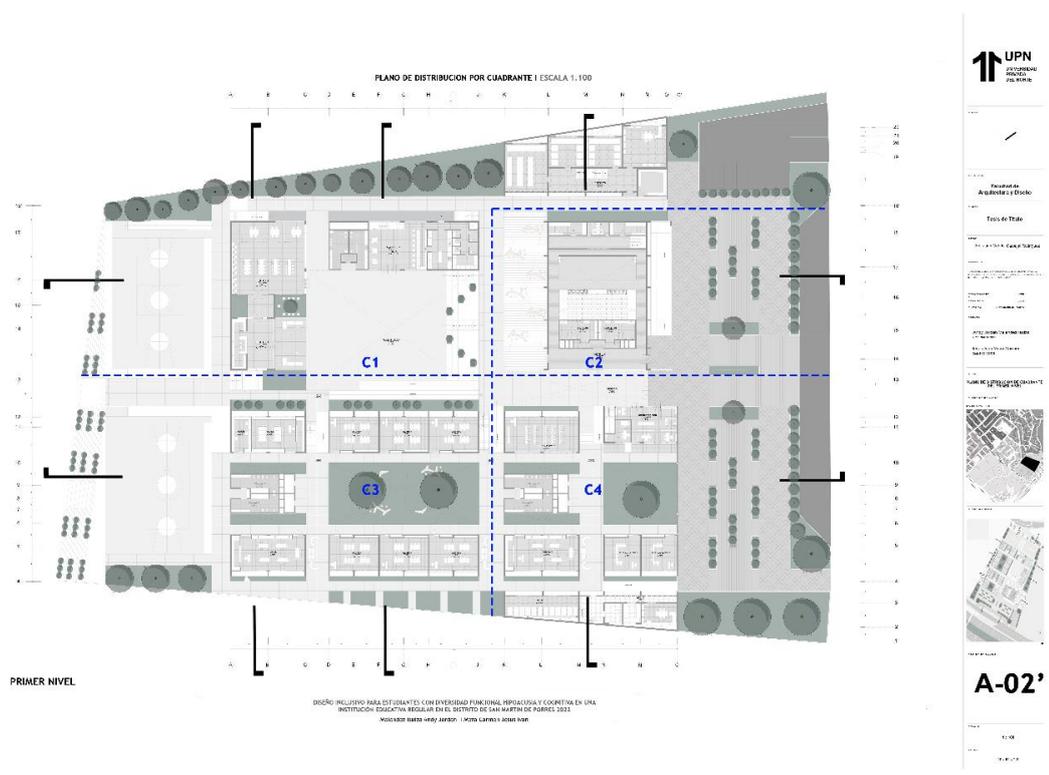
Plano cuadrante 1er nivel; fuente: propia
